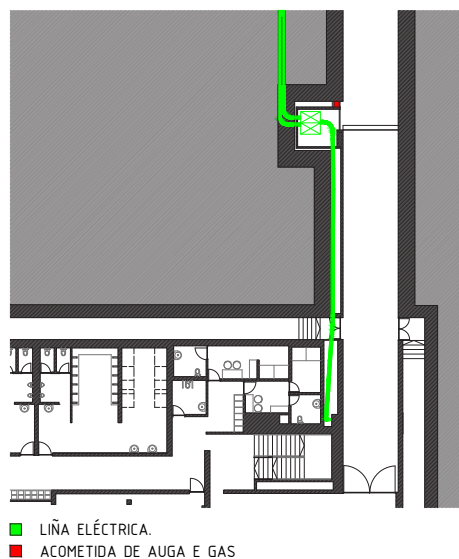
Recorrido en planta da liña eléctrica dende o posto de seccionamento ao transformador.
